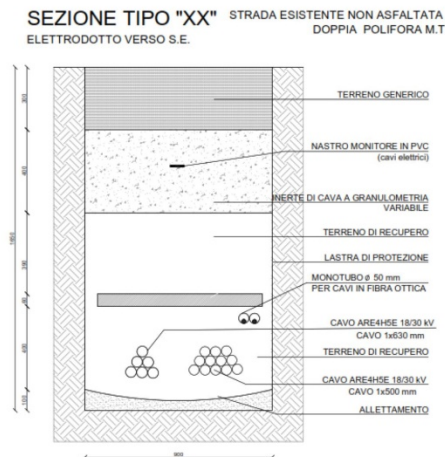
Sezione tipo XX del cavidotto esterno MT verso SE
